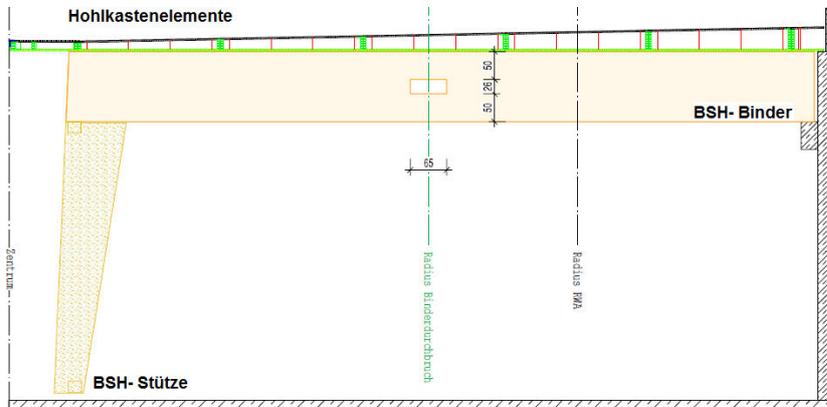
Hohlkastenelemente mit Dachneigung (Projekt B)⁴²⁶
